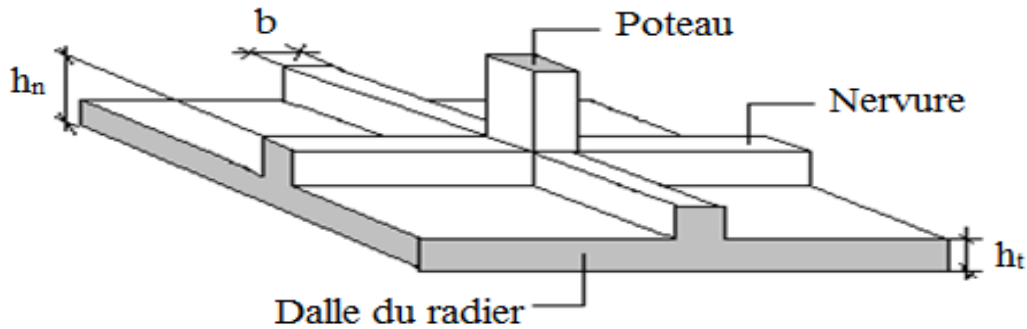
Disposition des nervures par rapport au radier et aux poteaux.
